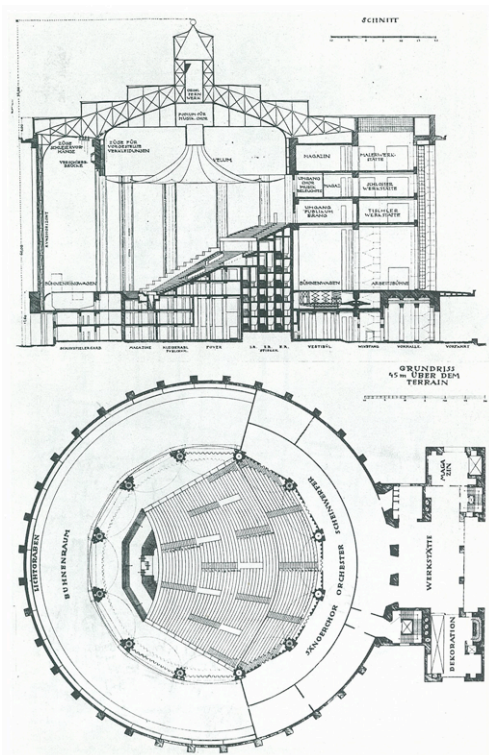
Oskar Strnad, Entwurf für ein Schauspielhaus in Wien, 1920, Schnitt und Grundriss.
